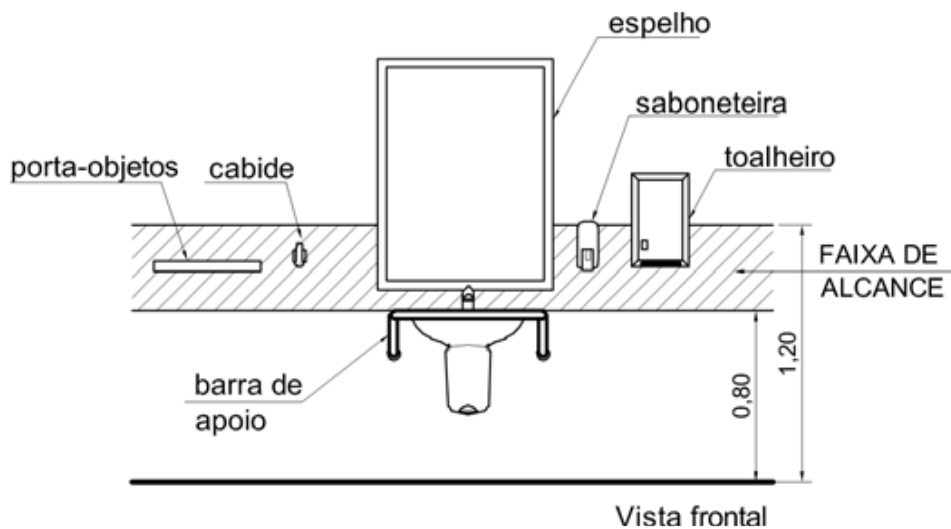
Exemplos de instalação de barras junto ao lavatório
